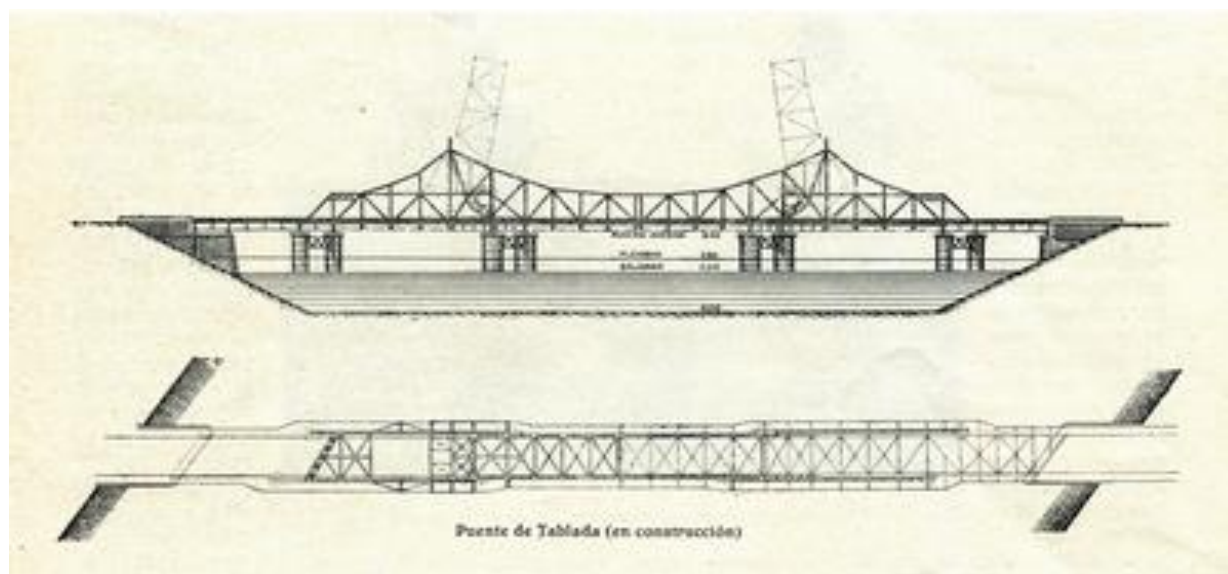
Planos del puente Alfonso XIII. Fuente: Revista Iberoamericana nº394.
